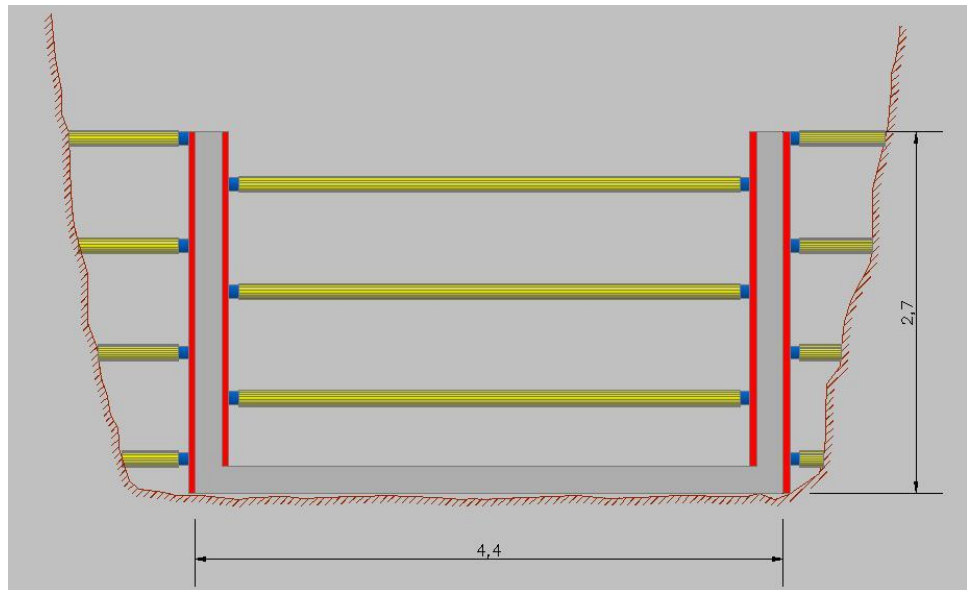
Esquema de Encofrado para la construcción del aliviadero
